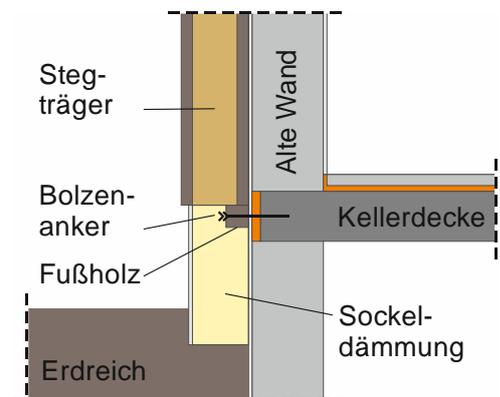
Alte Wand mit Kellerdecke, Sockeldämmung, Fußholz, Bolzenanker und Stegträger
